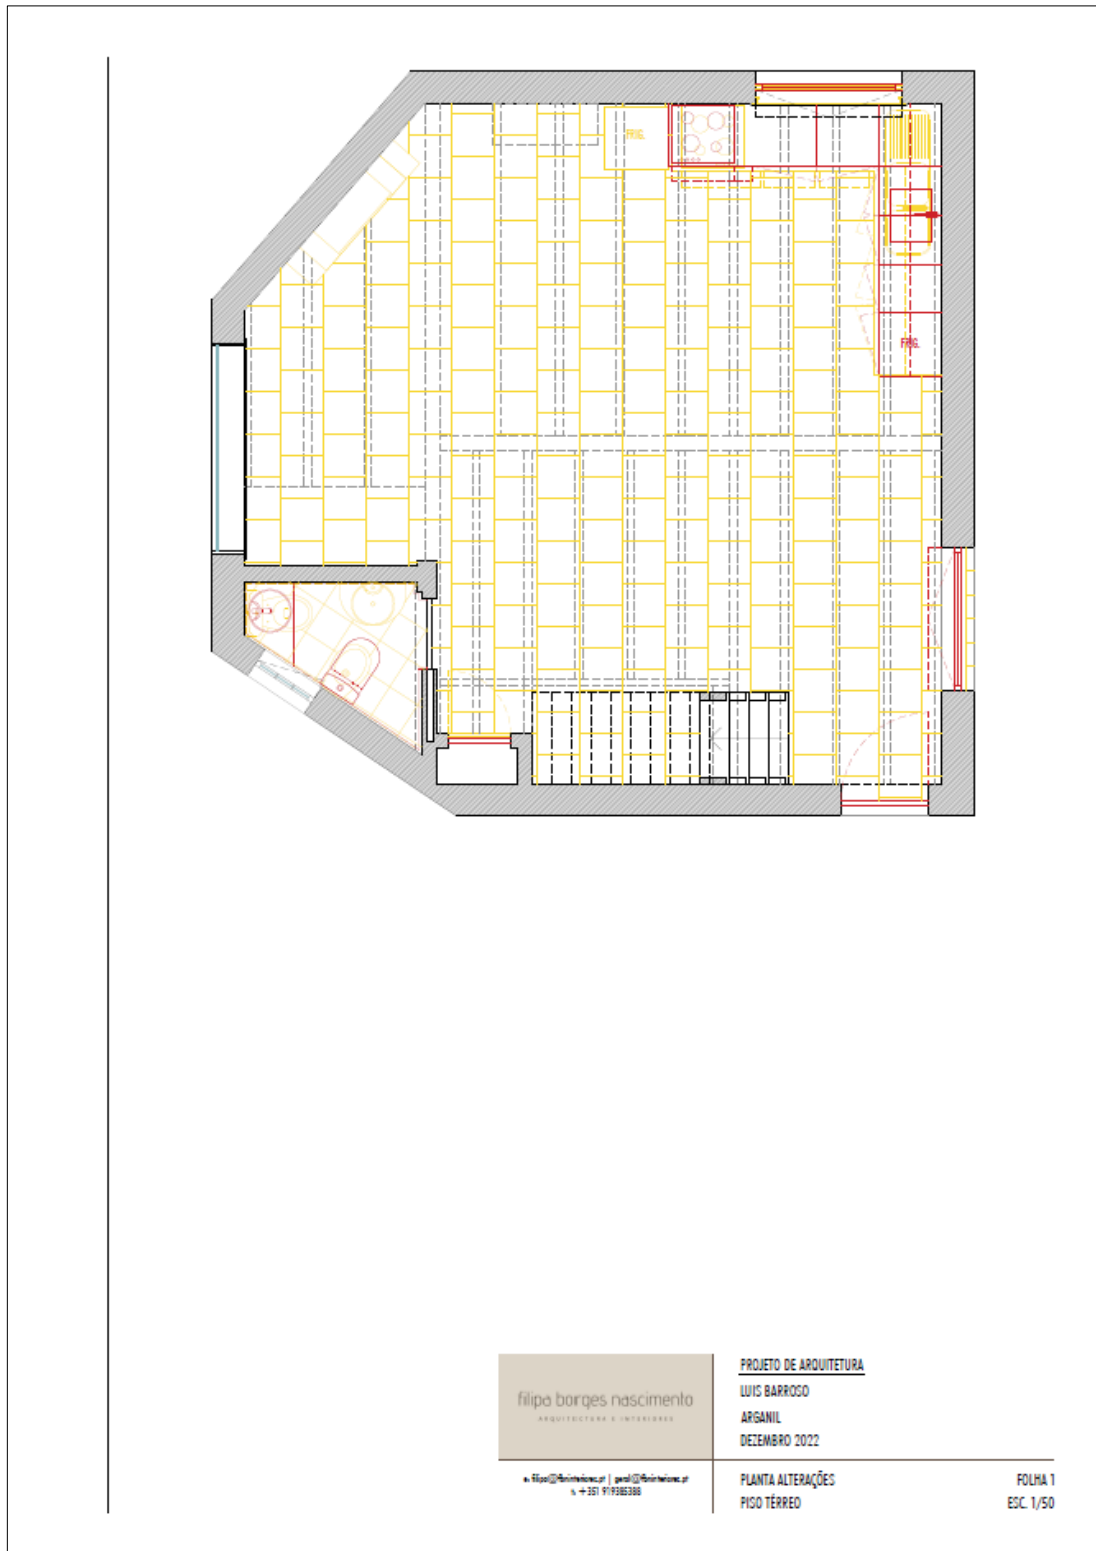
Planta de alterações (Fonte: Ana Soares, 2022)
